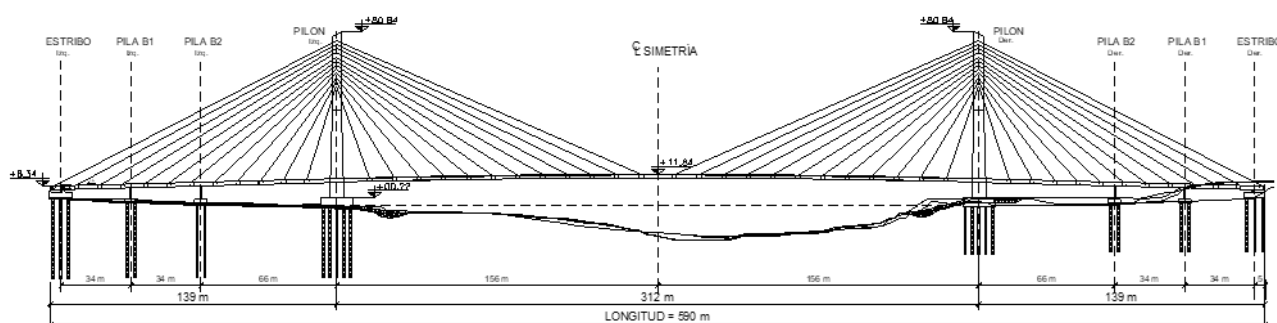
Perfil longitudinal del puente en tramo atirantado
